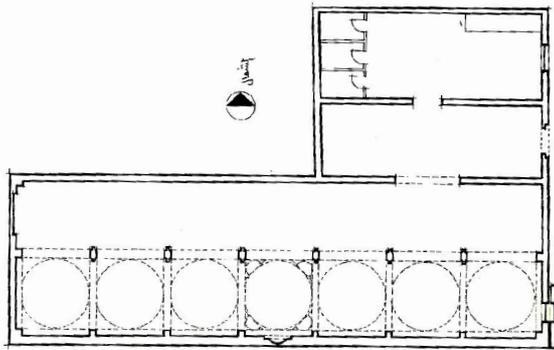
مسجد عمر بن الخطاب- المسقط الأفقي
